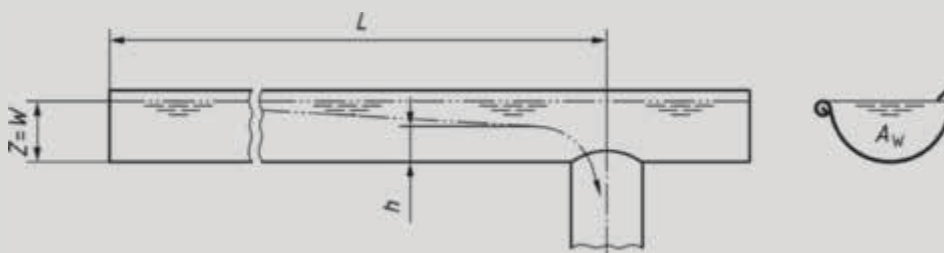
Bezeichnungen an vorgehängten Rinnen
